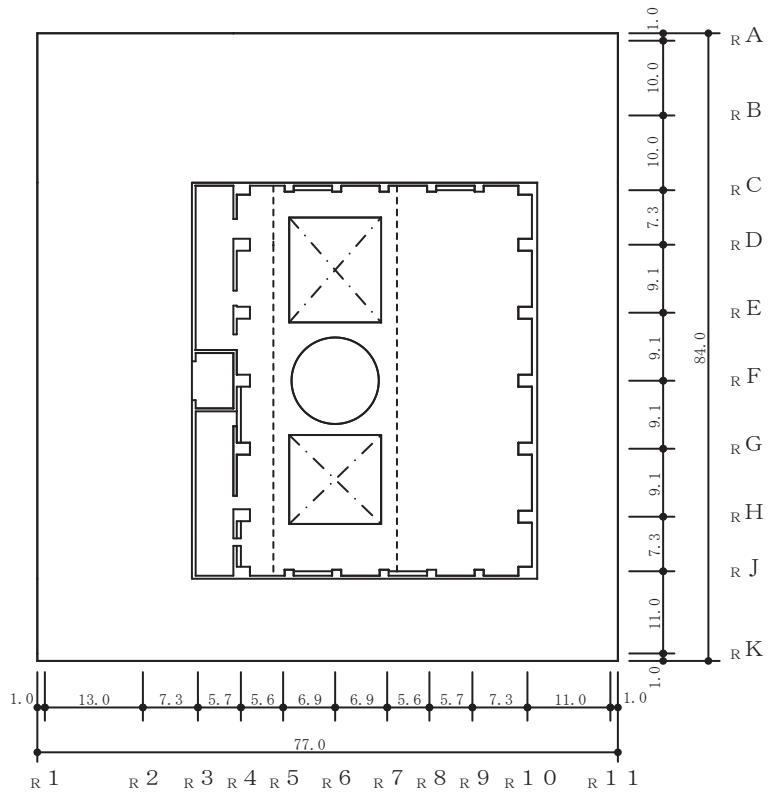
(4) 原子炉建屋の概略平面図 (0. P. 15.0m)
